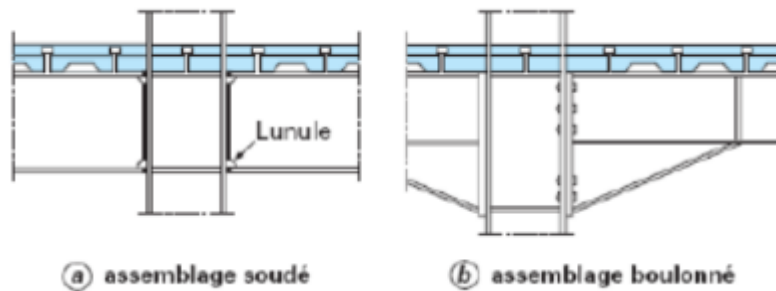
assemblage mixte sur résistant (en zone mixte )
